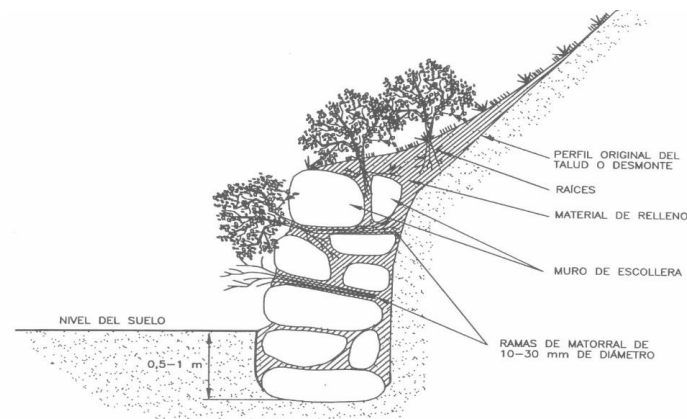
Escolleras vegetadas. Fuente: Elaboración propia a partir de Ingeniería de Caminos Rurales. USDA, Forest Service, 2005
